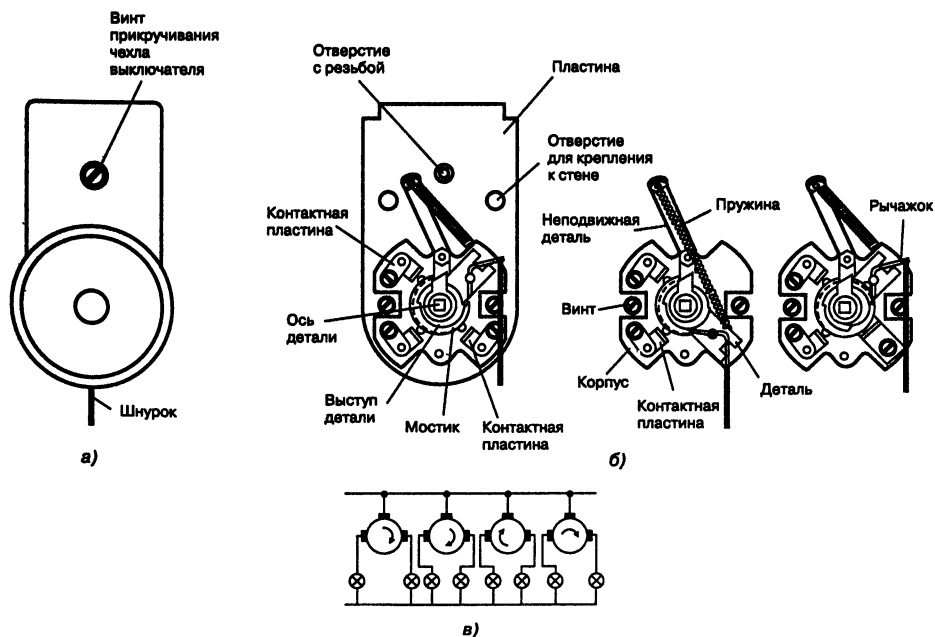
Подпотолочный переключатель со шнуровым приводом для открытой установки
